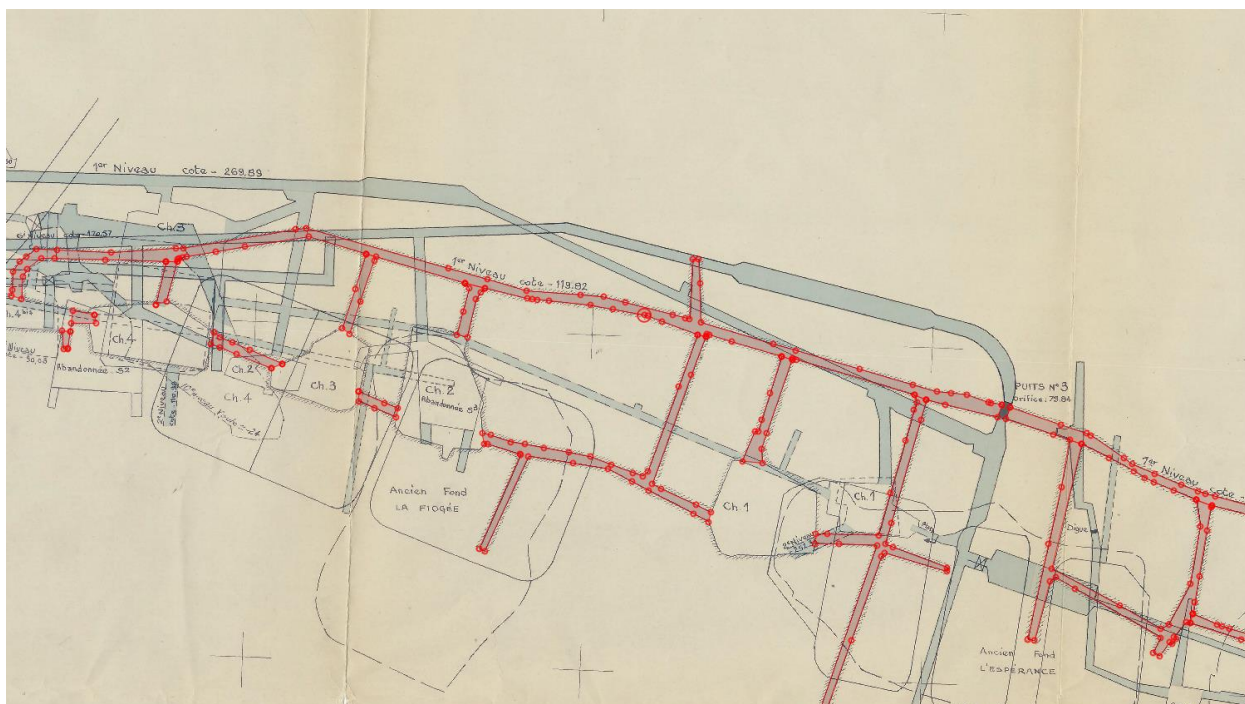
illustration du travail de digitalisation sur les plans sur SIG. (Extrait du plan de La Pouëze : Ardoisière de La Pouëze : Plan et Coupe (Ardoisière d'Anger 1990) Visualisation sous logiciel SIG)
